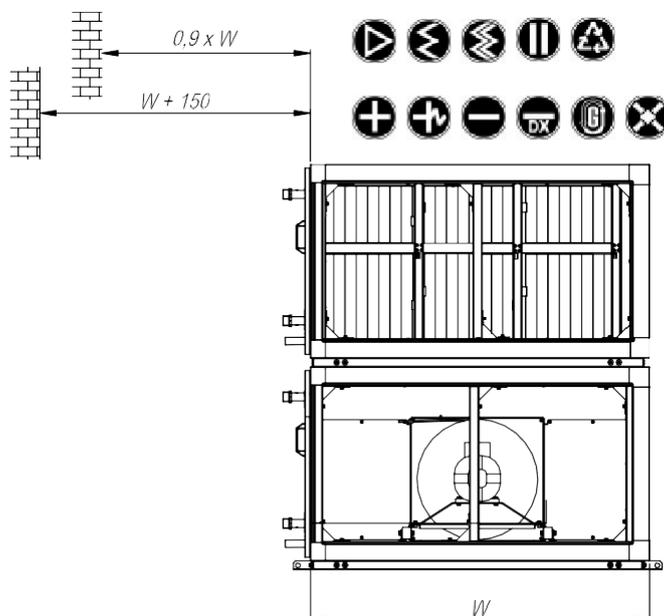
Espace libre au niveau de la façade – centrale de traitement d'air LXVVS 21-650
